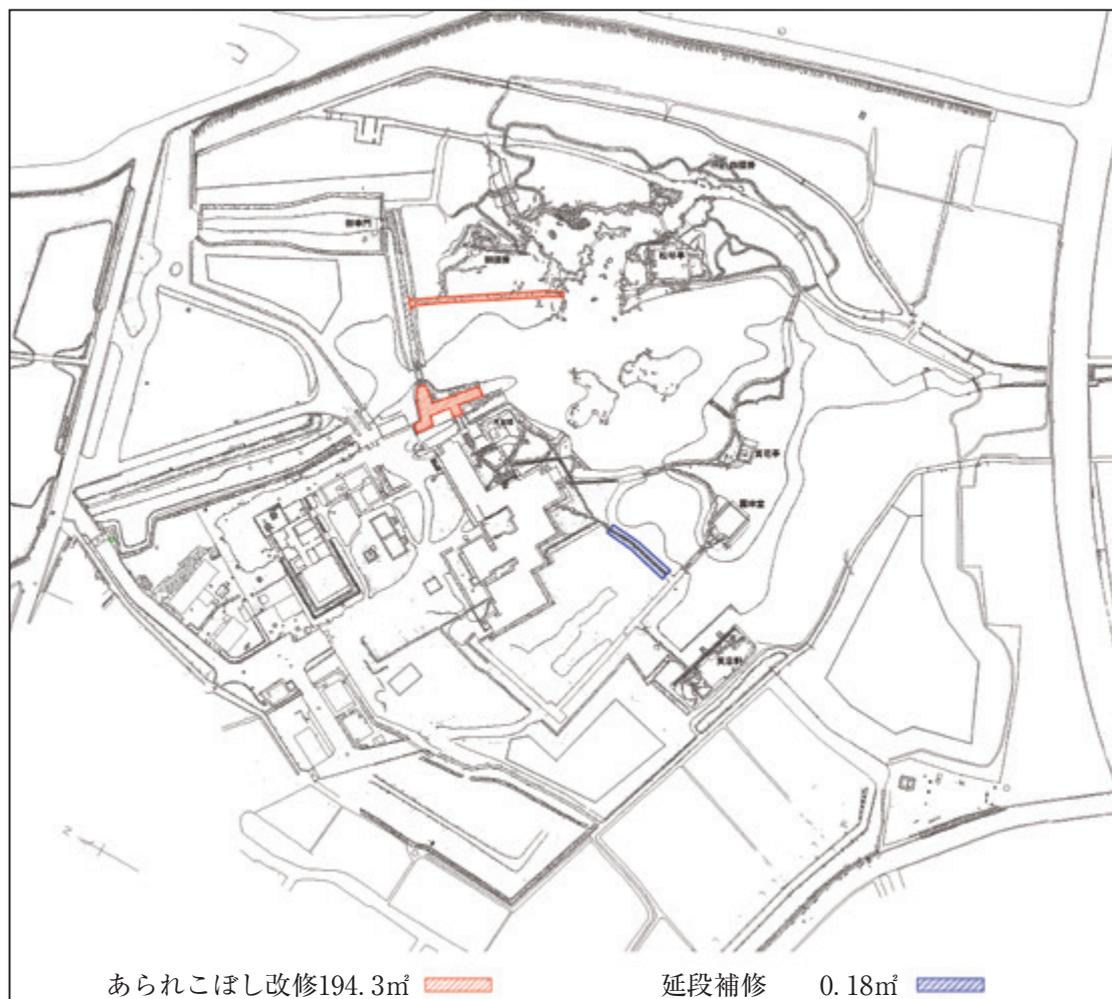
平成29年度 桂離宮苑地整備工事 施工平面図
